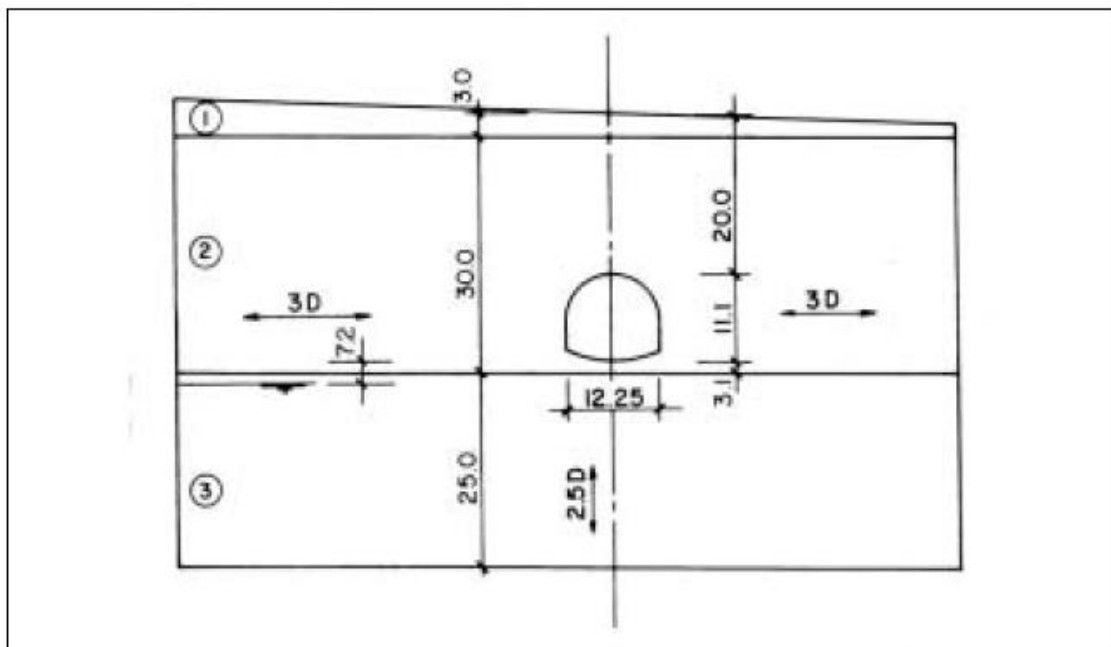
Coupe géotechnique et dimensions de l'ouvrage [6]
